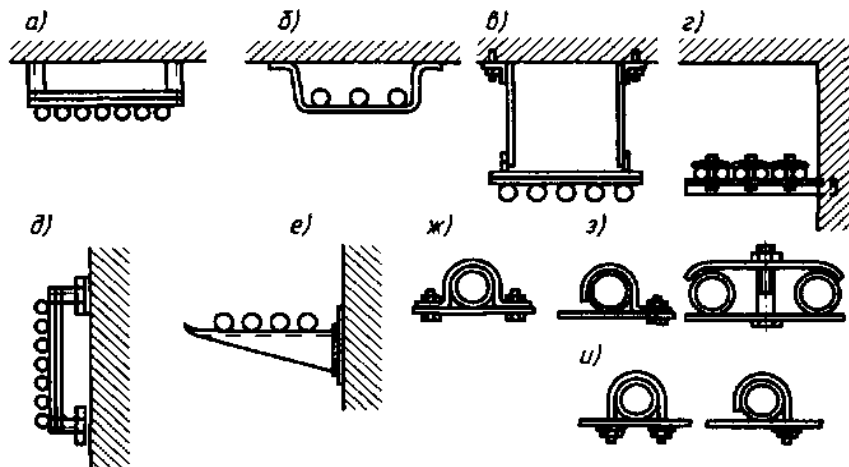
Опорные и крепежные конструкции и детали для трубных электропроводок:
